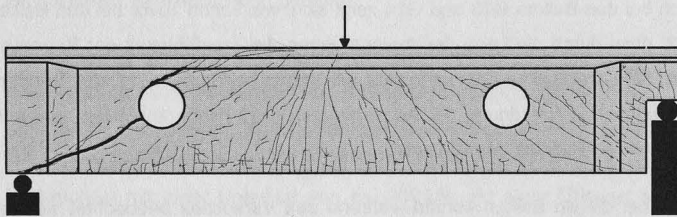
Rissbild Balken G13 bei Erreichen der Traglast
